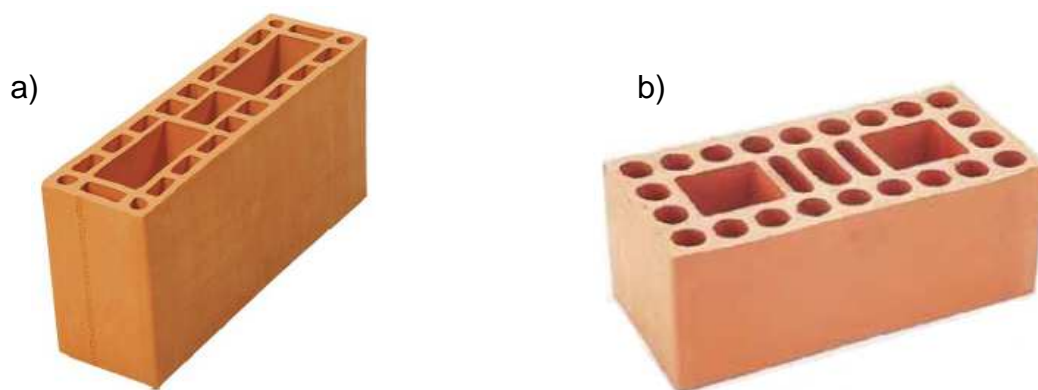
Tijolos estruturais. a) paredes vazadas; b) perfurado.
